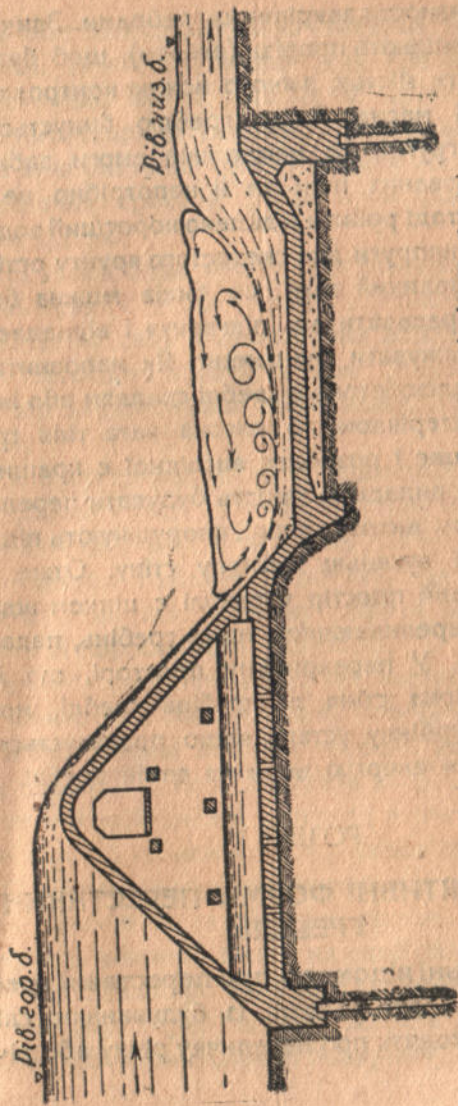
Розріз через залізобетонну греблю на звітрлому ґрунті
